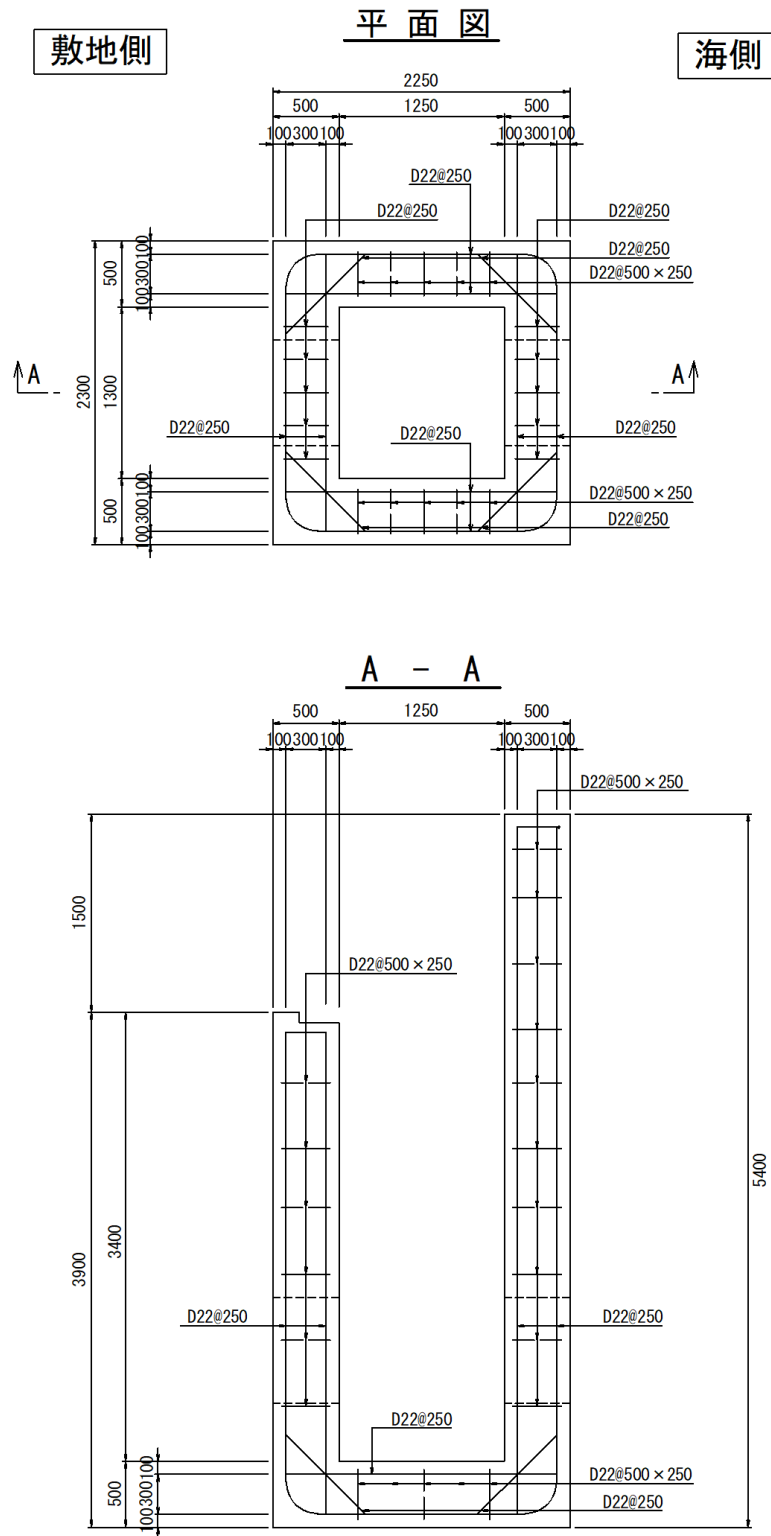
(3) 概略配筋図 (集水桝 (屋外排水路逆止弁⑦))
